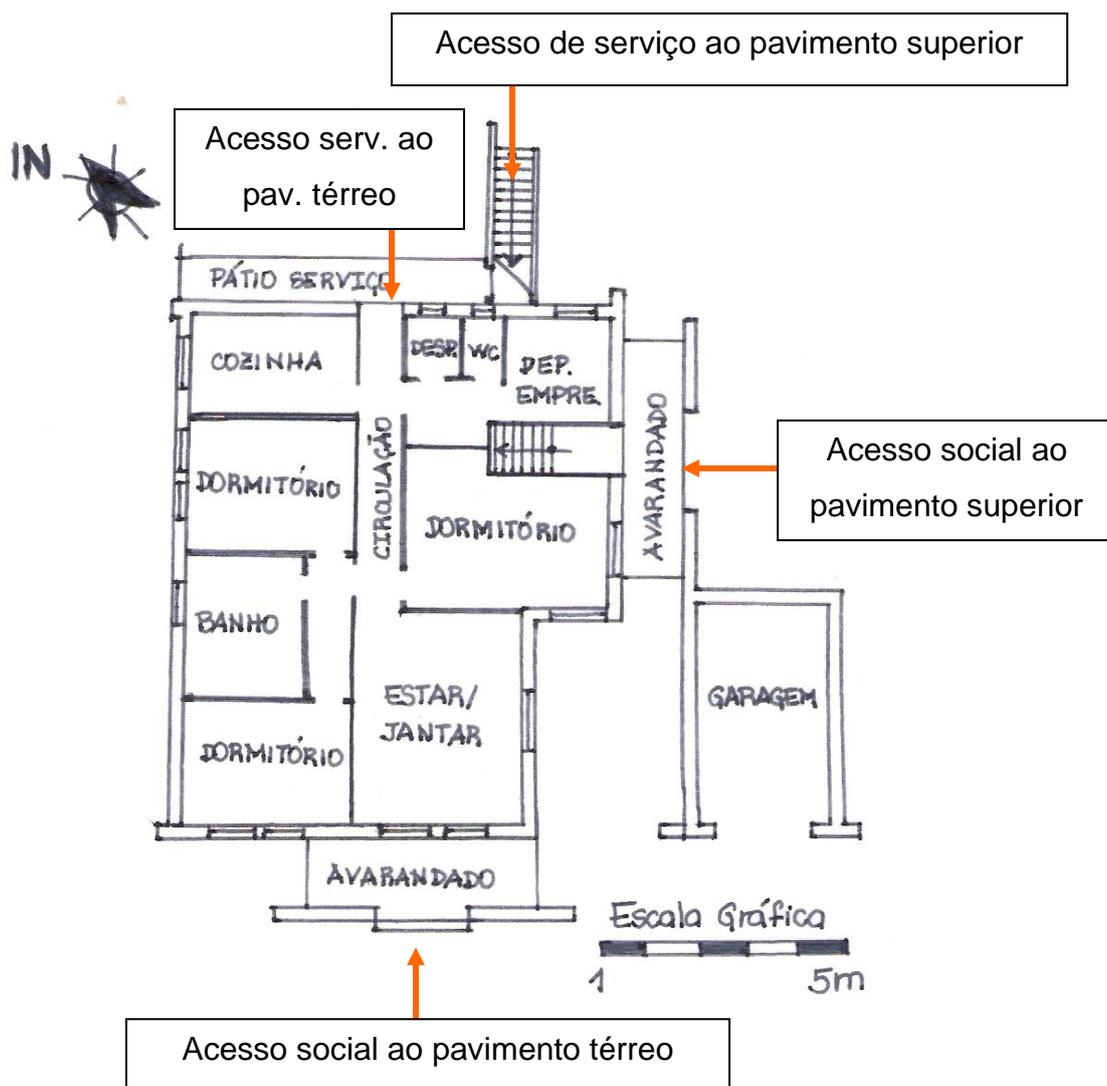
Planta baixa da edificação – Pavimento térreo.
